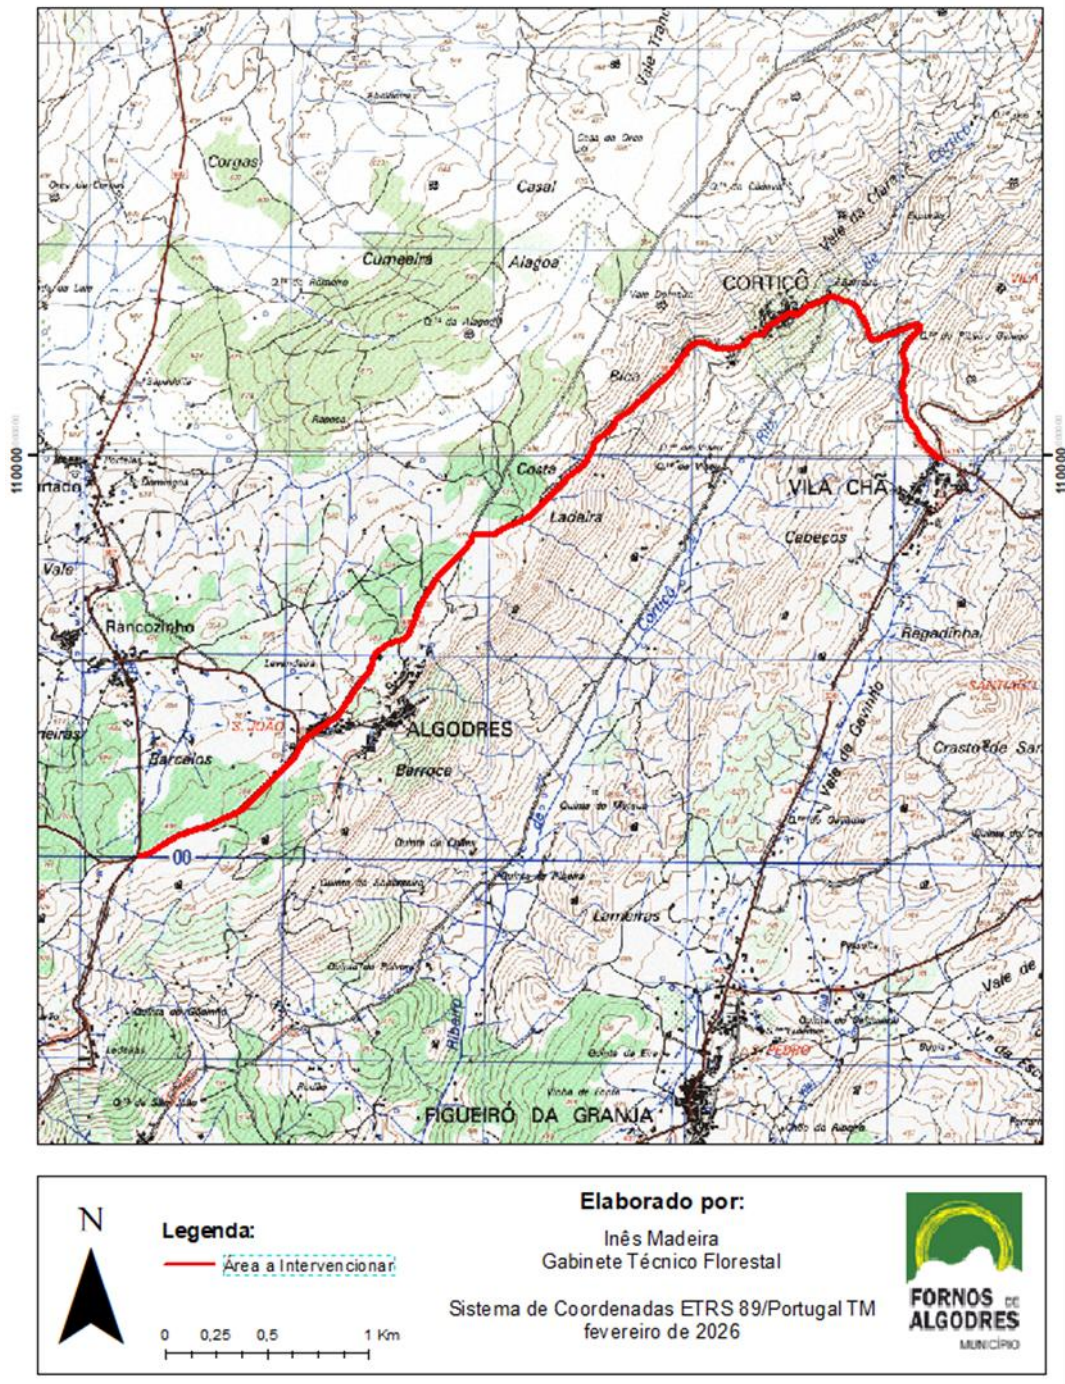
Planta de localização EM587-5 Algodres/Vila-Chã
